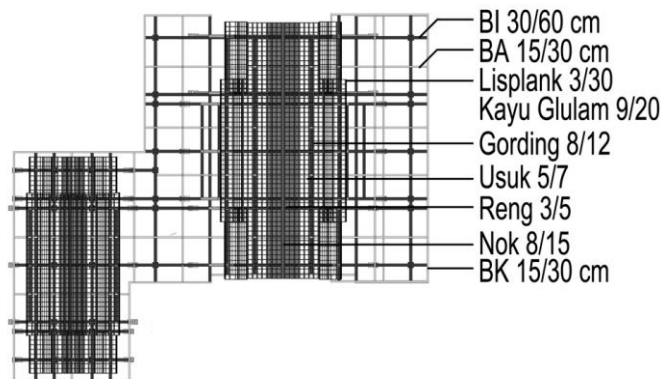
Aksonometri Struktur Massa Berlantai 1
